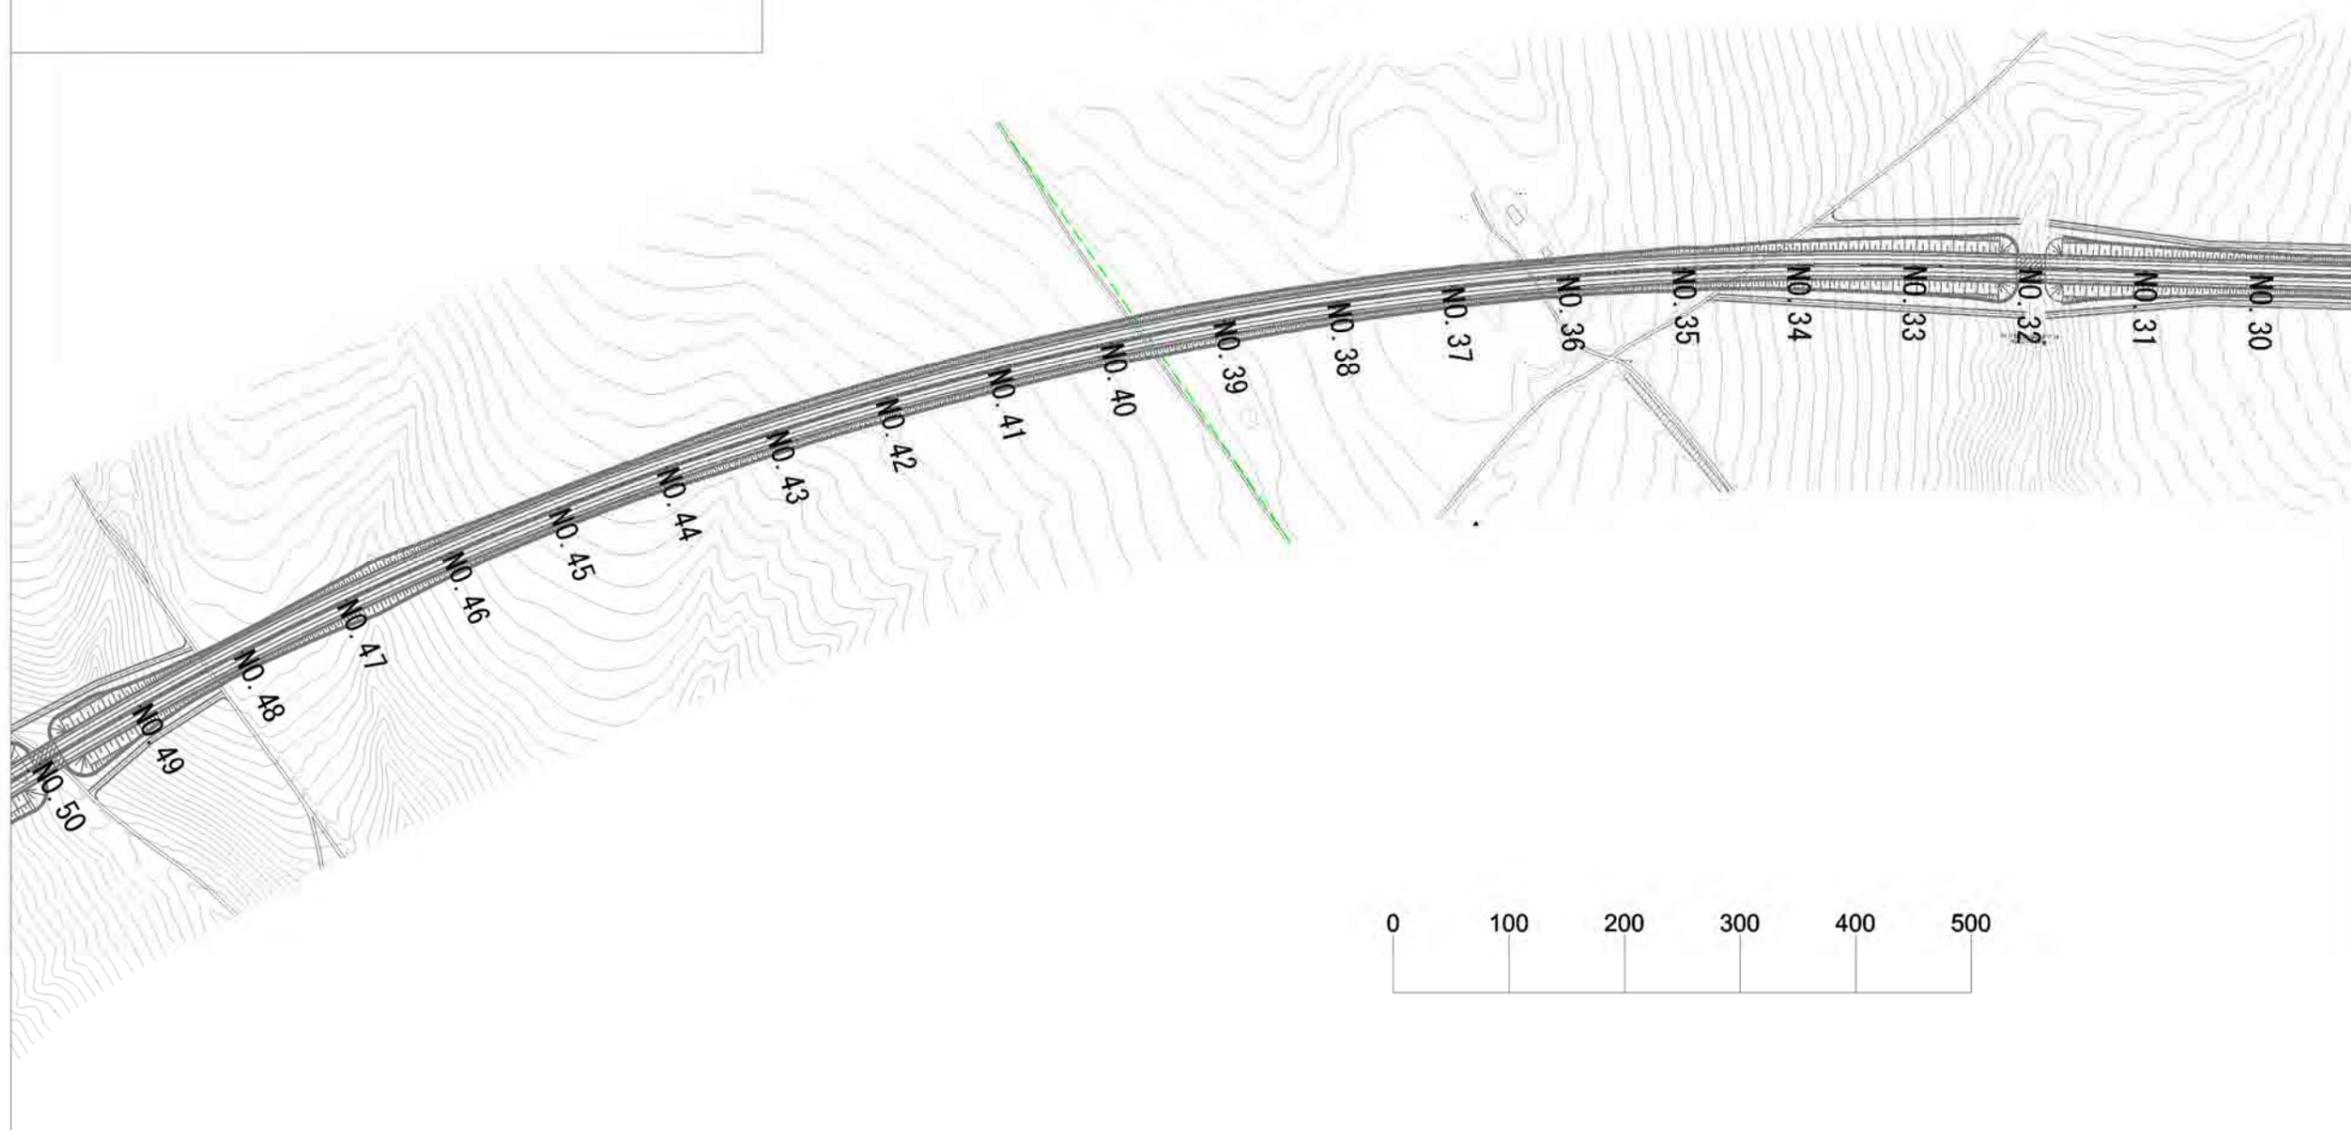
地下埋設物および上空架線 施設図(2/8)
